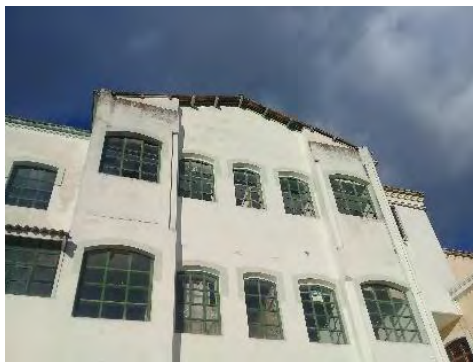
Suciedad en las fachadas internas ala oriental. Fuente: Elaboración Propia.
